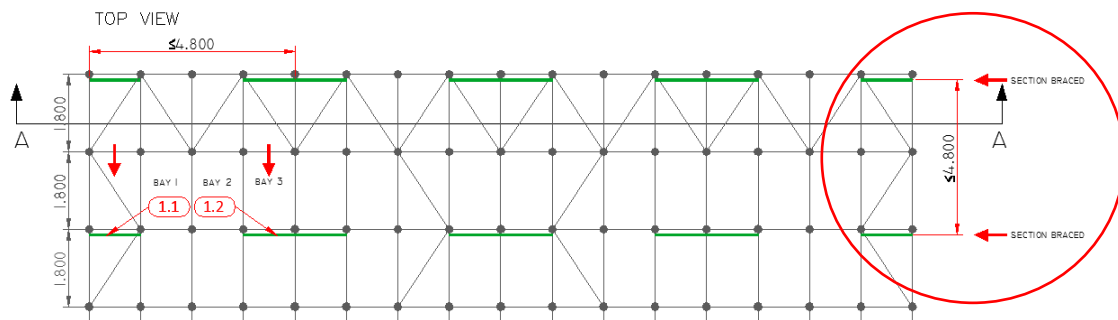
竖向斜杆（纵向）支架纵间距1.2m 平面图
